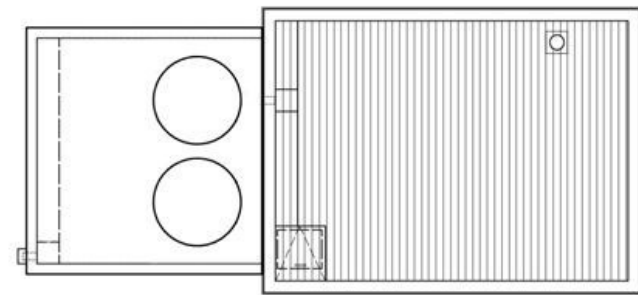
Planta de cubierta. Fuente: Crosson Architects, 2014
